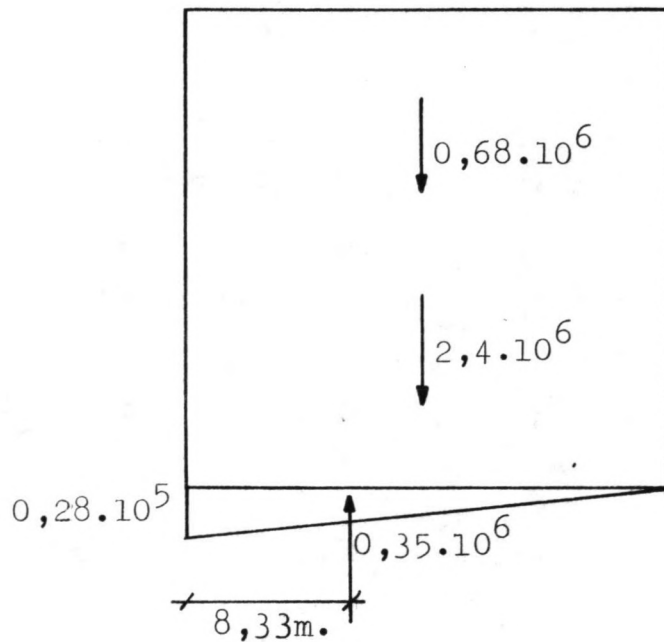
Verticale belasting doorlaatcaisson
